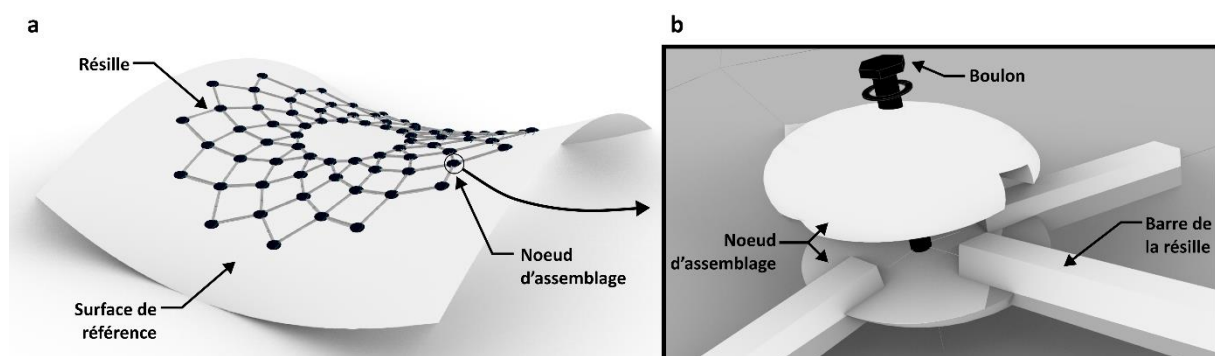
Génération de la résille (a) et définition de la géométrie du nœud constitué de deux parties assemblées par un boulon (b)
